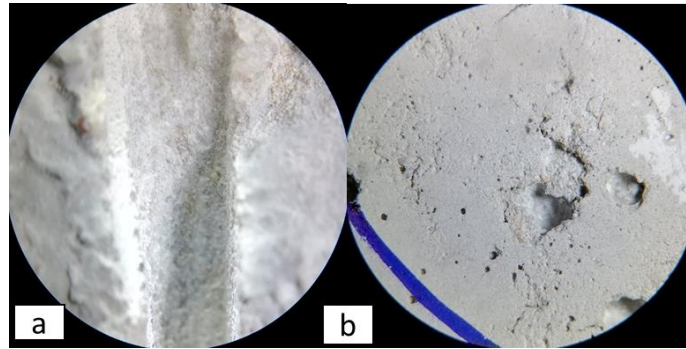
Probeta Piedra 4 2b con 2 ml de Aditivo Bacteriano. (a) vista interna de la fisura inducida (b) vista de discontinuidades y fisuras superficiales presentes en el concreto. Evaluación a los 14 días.
